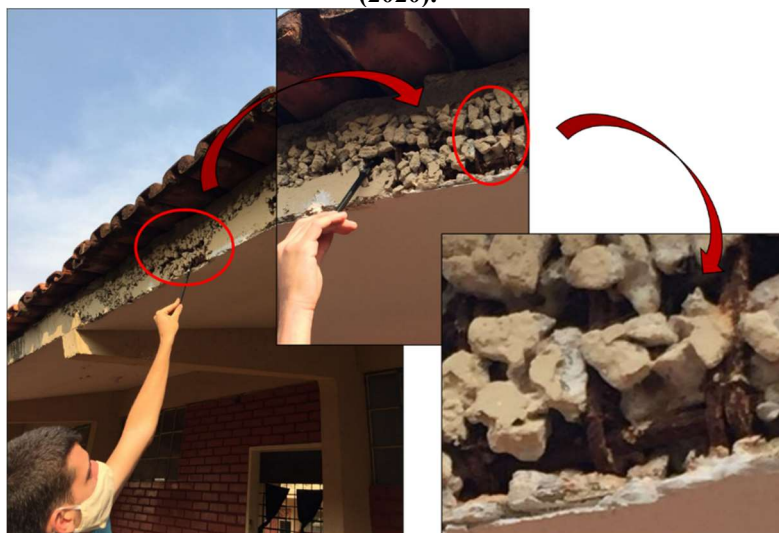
Laje com infiltração e fissuras. Fonte: Autor próprio (2020).
